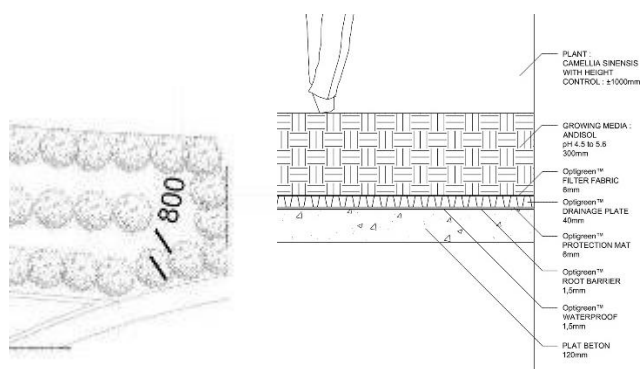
Penghijauan menggunakan tanaman teh pada green roof bangunan.
